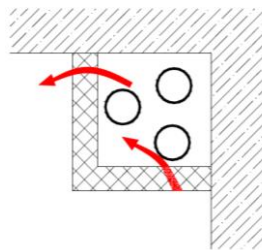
Falta de isolamento acústico nas *courettes
